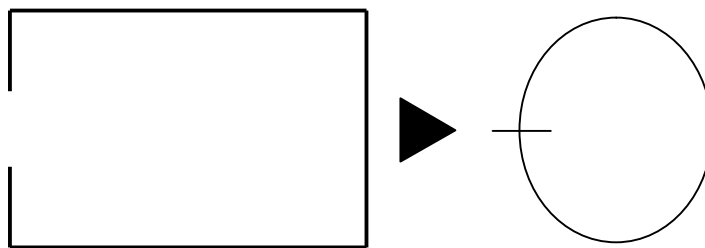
Пример зальной схемы объемно-планировочной организации здания
